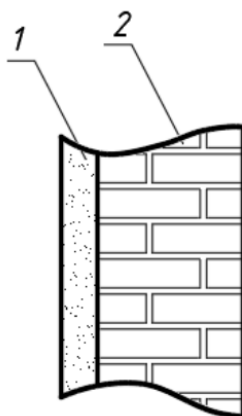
Фрагмент наружной стены. 1- штукатурка сухая; 2- кладка кирпичная
